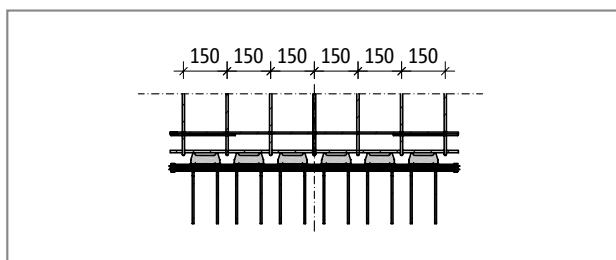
Schöck Tronsole® tipo T: passo armatura pari
